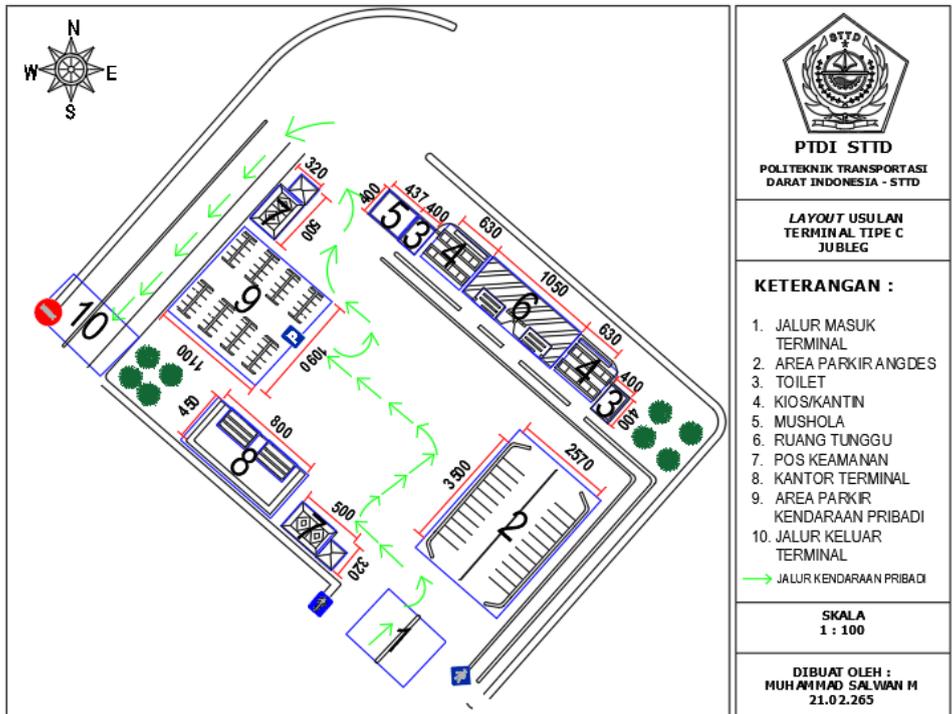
Layout Usulan Terminal Tipe C Jubleg
